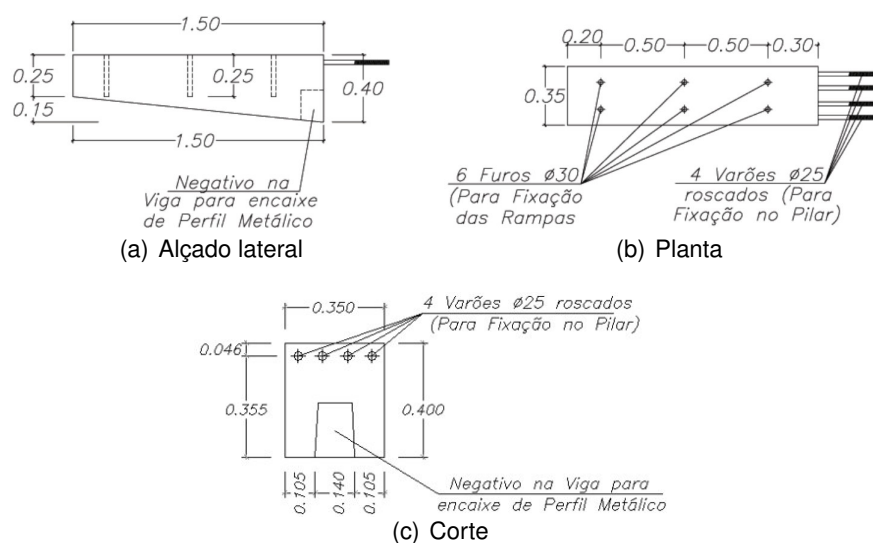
Pormenor de ligação rampa-pilar intermédio [14].
